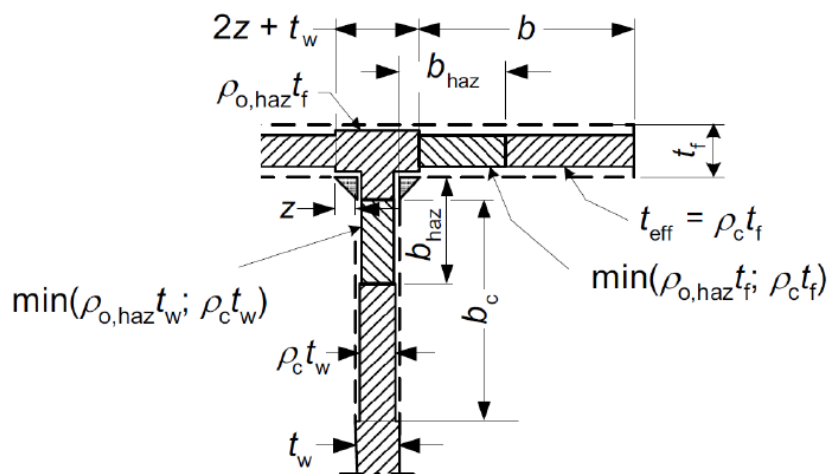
Sezione efficace per effetto dell'instabilità locale e delle HAZ.
